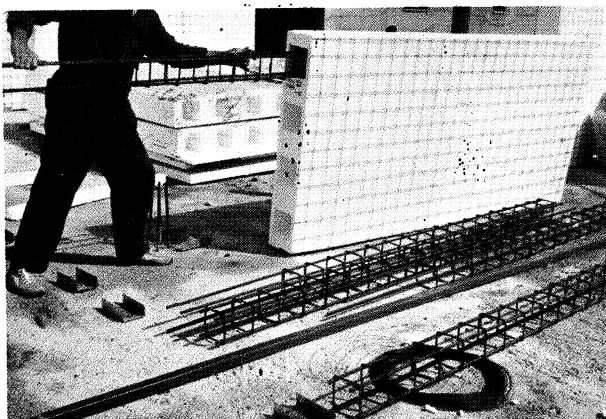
Colocación de armaduras de pilares en paneles D-P.II.
